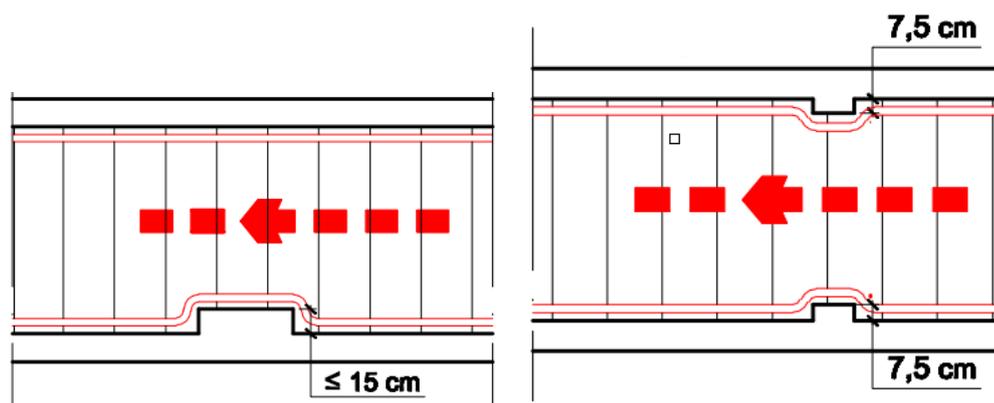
Indicação de estreitamento de lanço de escada por pilar ou coluna em um dos lados
